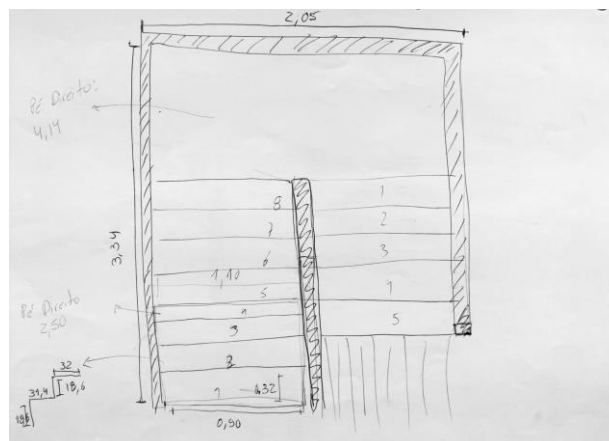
Levantamento de medidas das escadas do piso 1. Fonte: Ana Ferreira.
